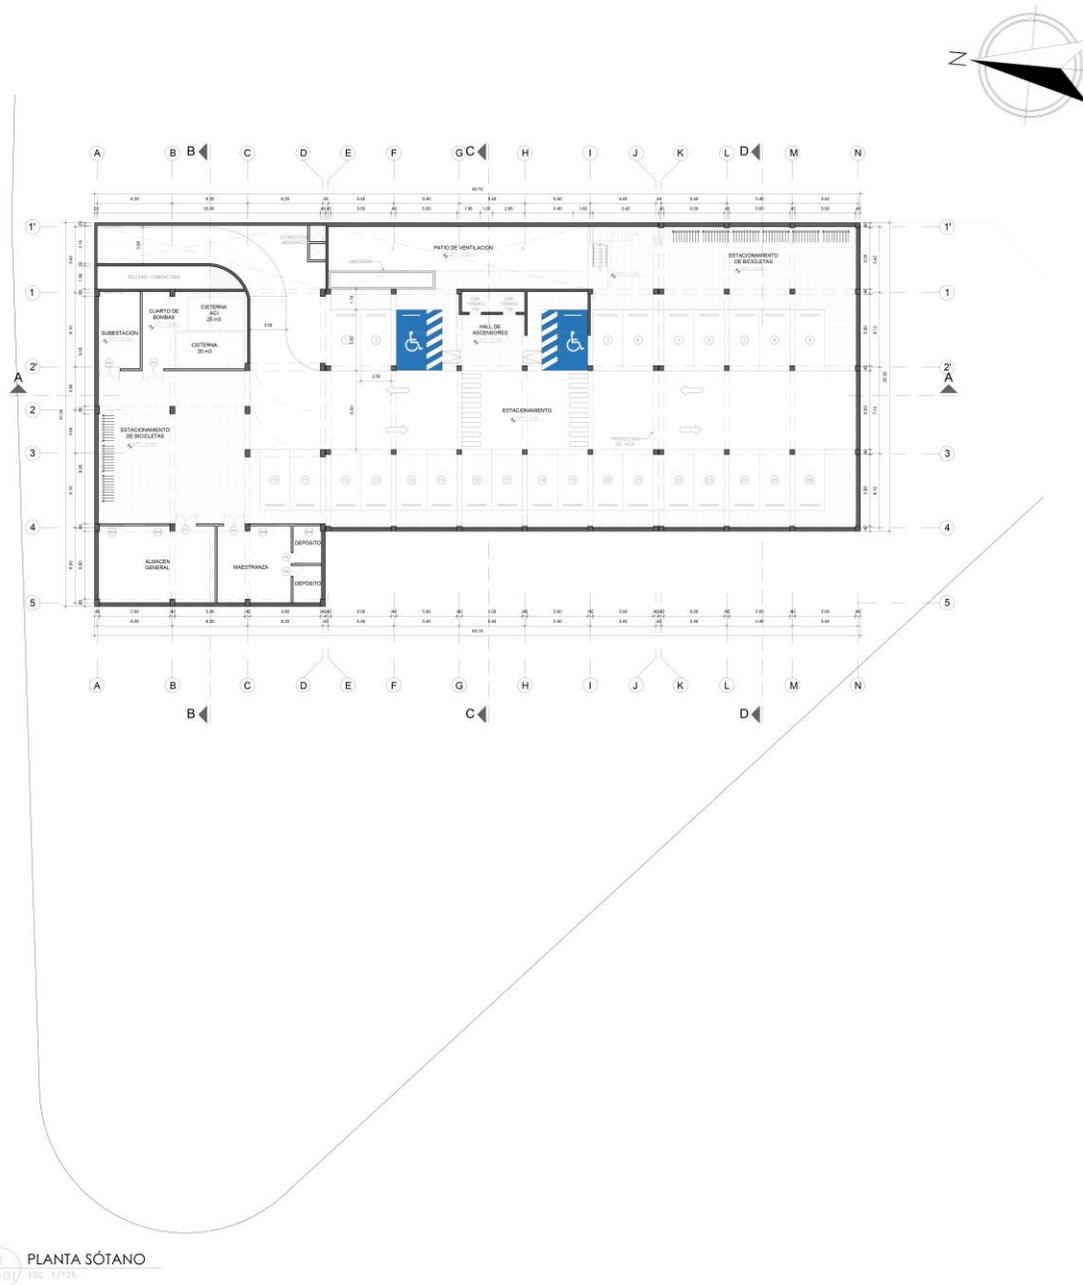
Planta de sótano. Fuente: Elaboración propia.
